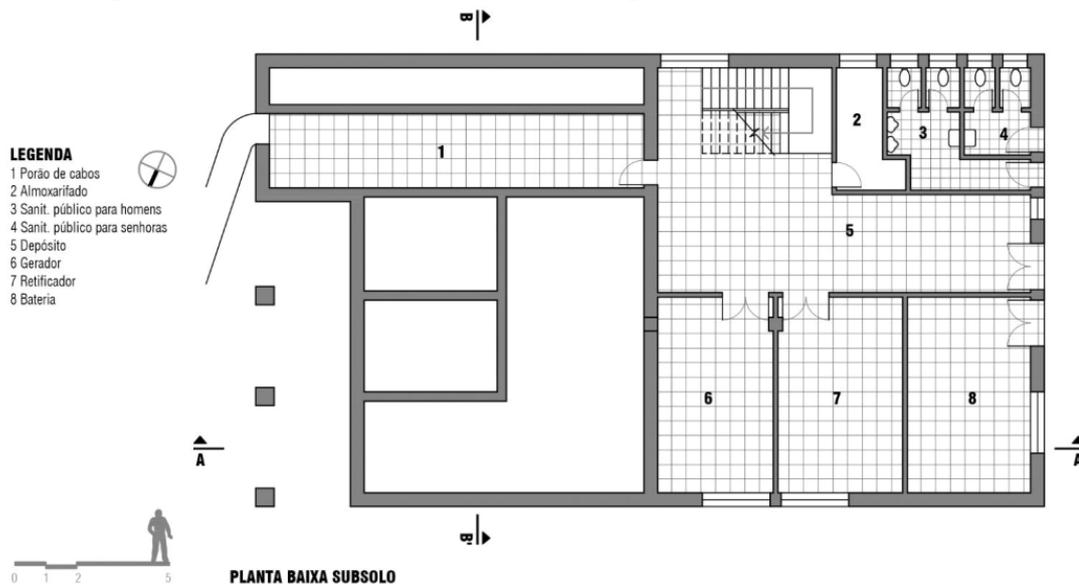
Planta Baixa do Subsolo do Projeto da Cia Telefônica Municipal
